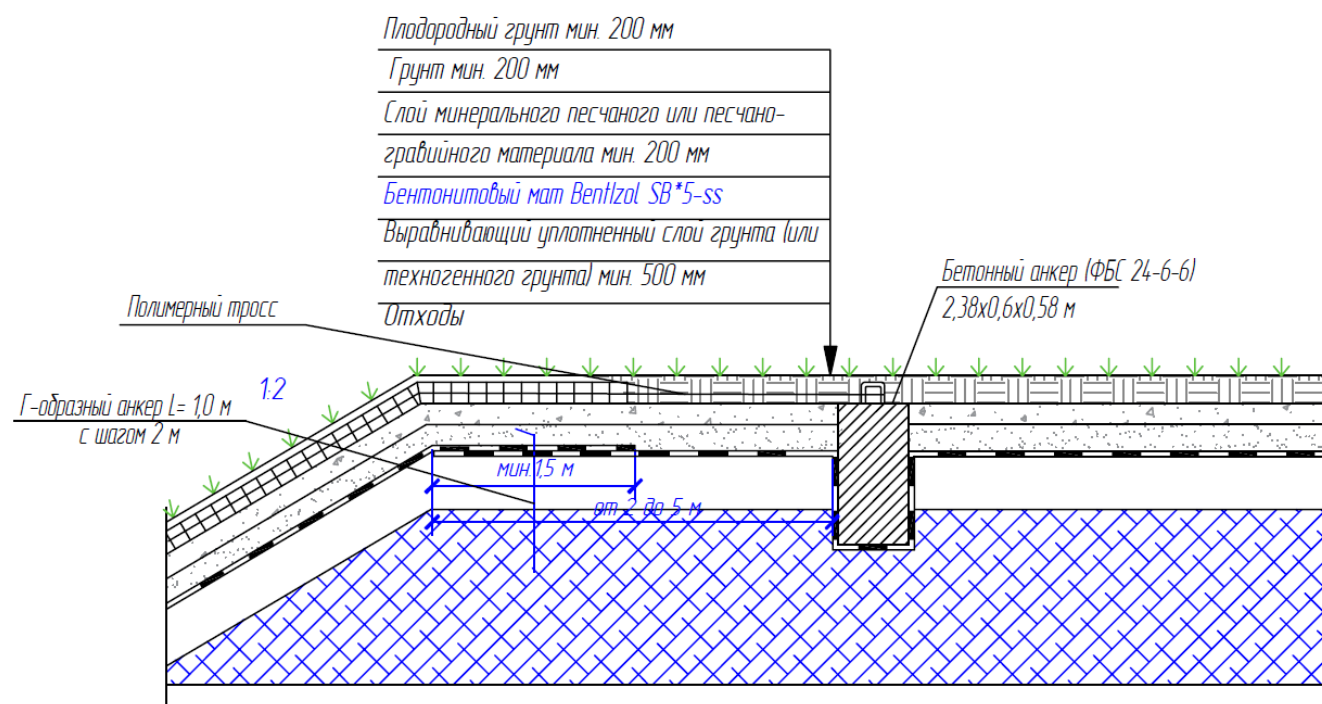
Схема внешней гидроизоляции на вершине откоса.
